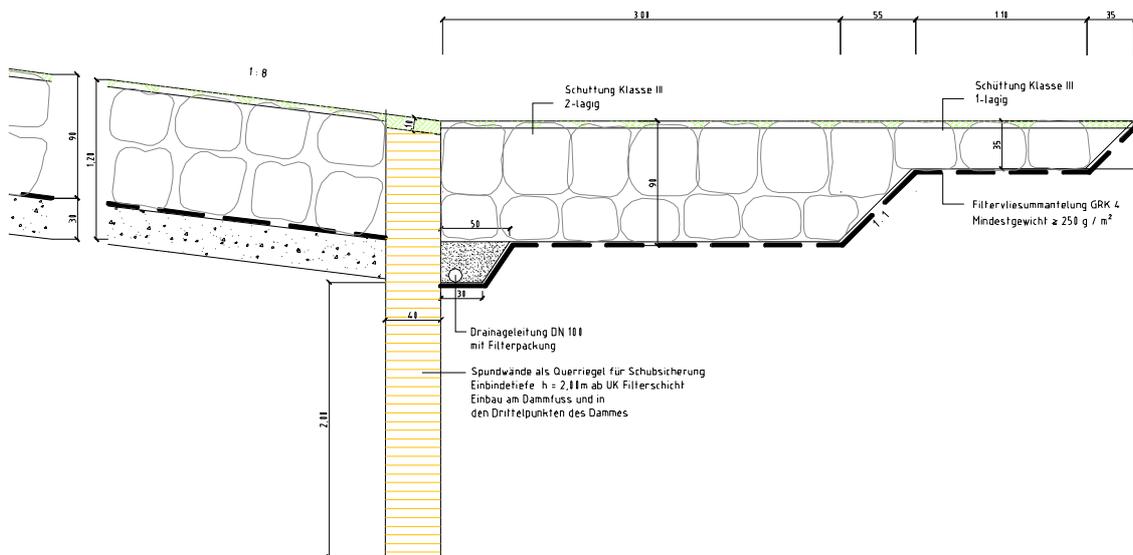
Dammfußsicherung zur Steinschüttung in Lockerbauweise
